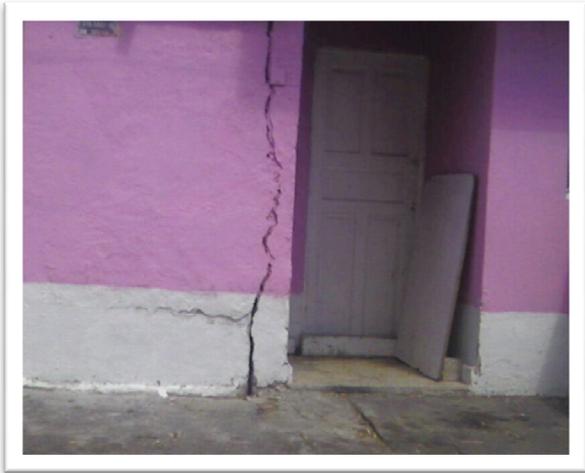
Casa en Santa Cruz Meyehualco con grietas en las paredes
